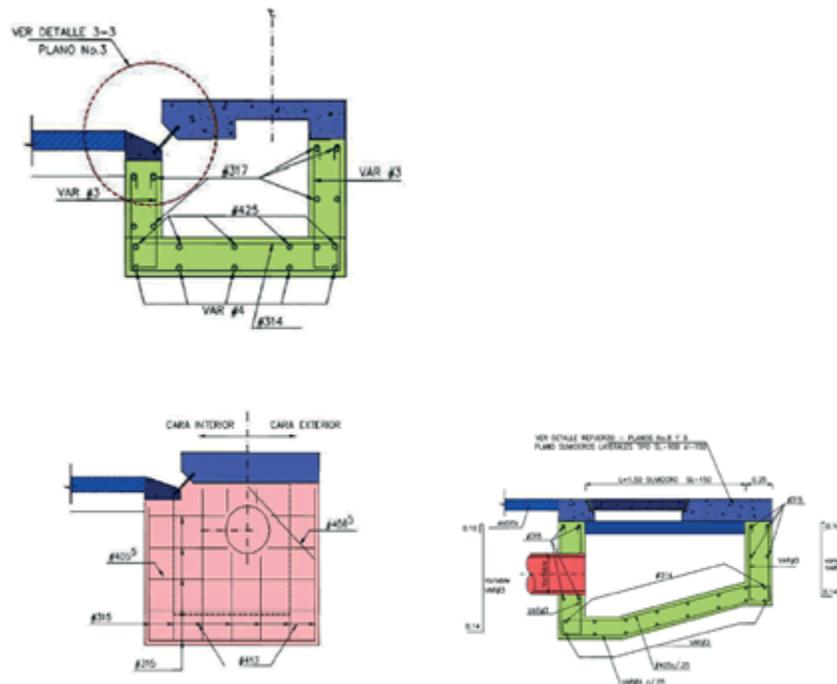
Sumideros laterales tipo SL-100 y SL-150 - Planta, refuerzo y cortes
